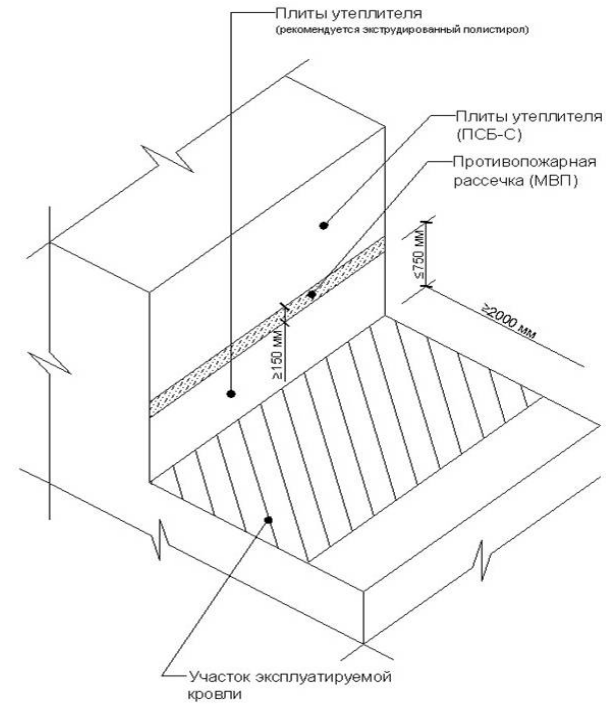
Участки здания с разновысокой кровлей выполненной по контуру сопряжения с примыкающей к ней сверху СФТК, в том числе и на «глухих» (без проёмов) участках фасада, как «эксплуатируемая» на расстояние не менее 2 м от границы их сопряжения
